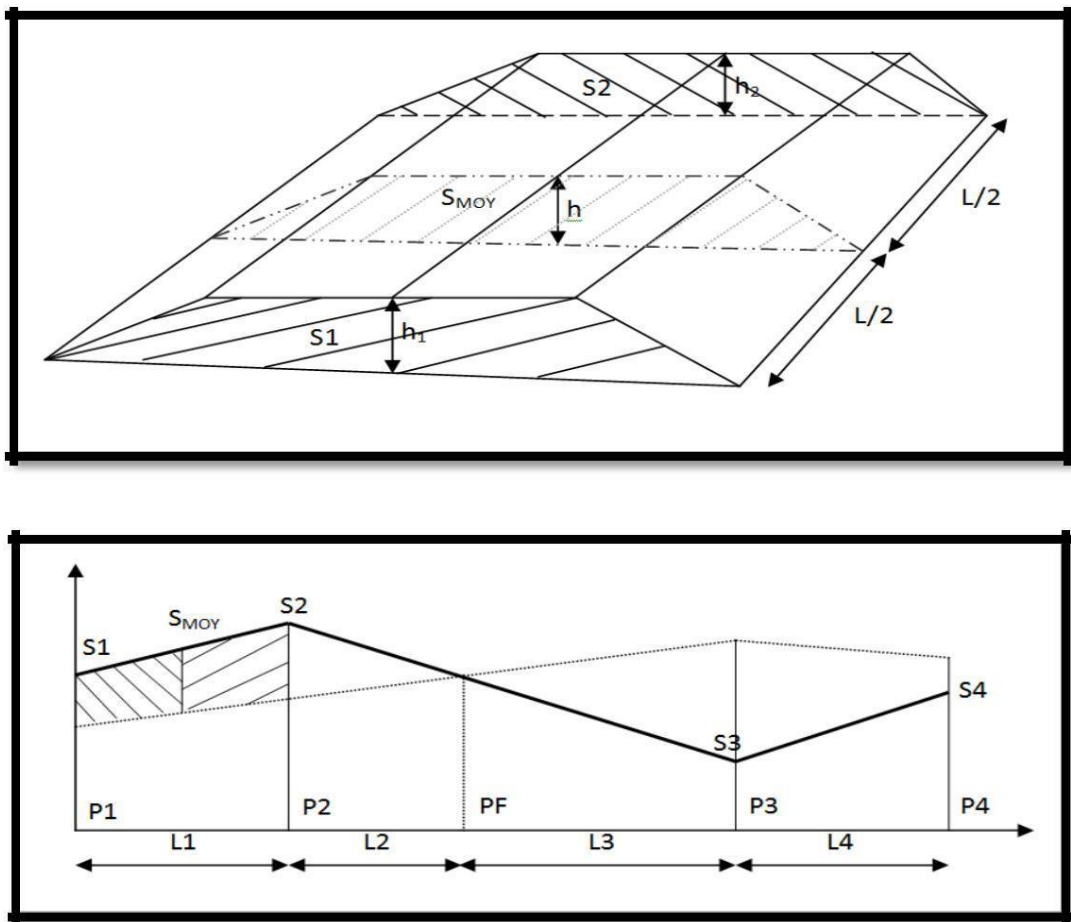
Les sections des profils en travers d'un tracé donné.
